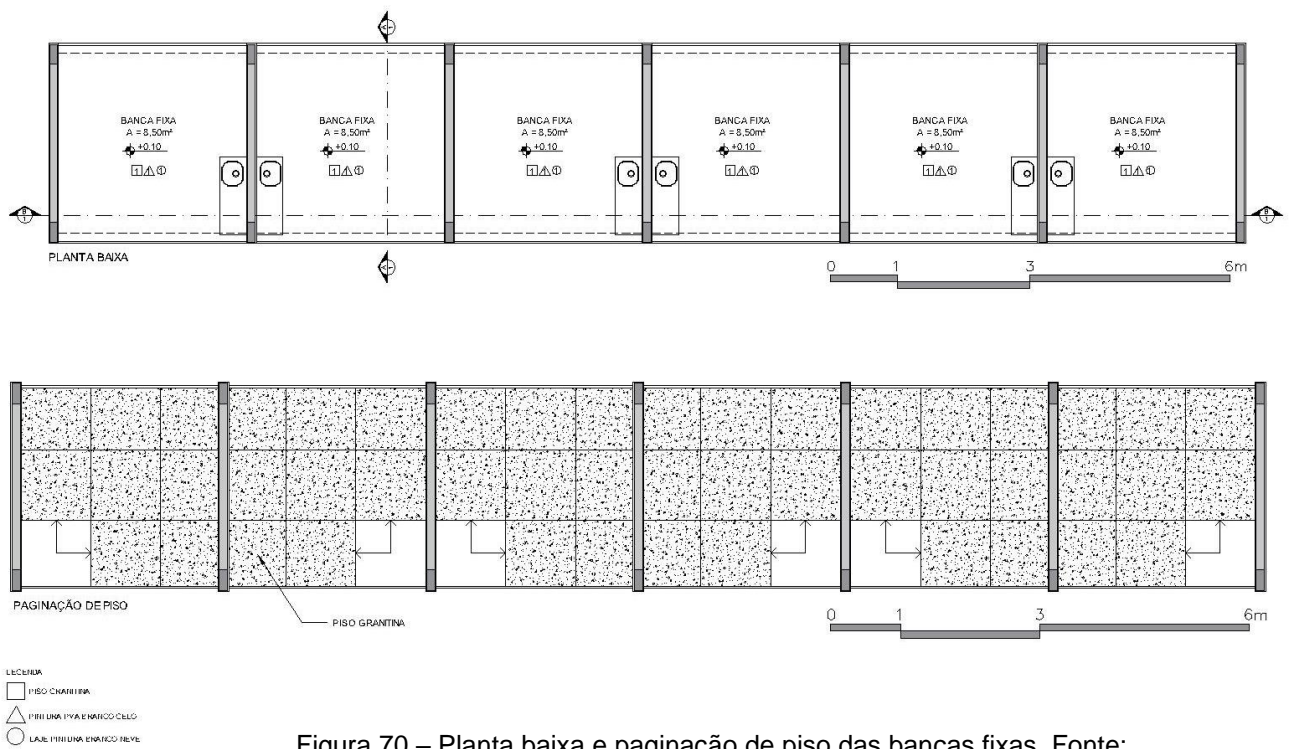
Planta baixa e paginação de piso das bancas fixas. Fonte: Elaboração própria.+
